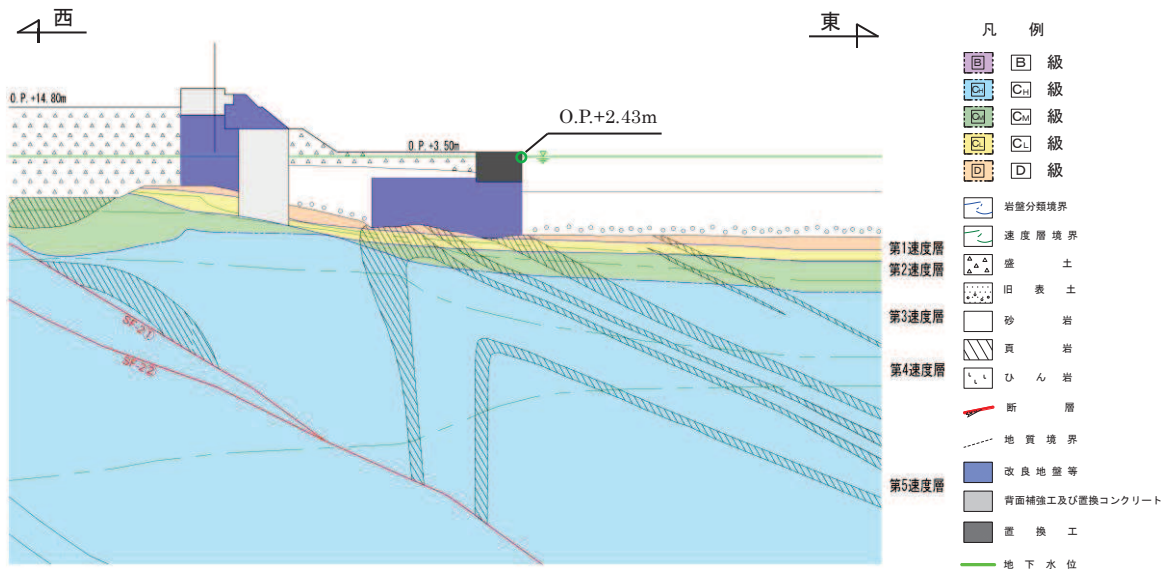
前面護岸 評価対象地質断面図 (A-A 断面)
